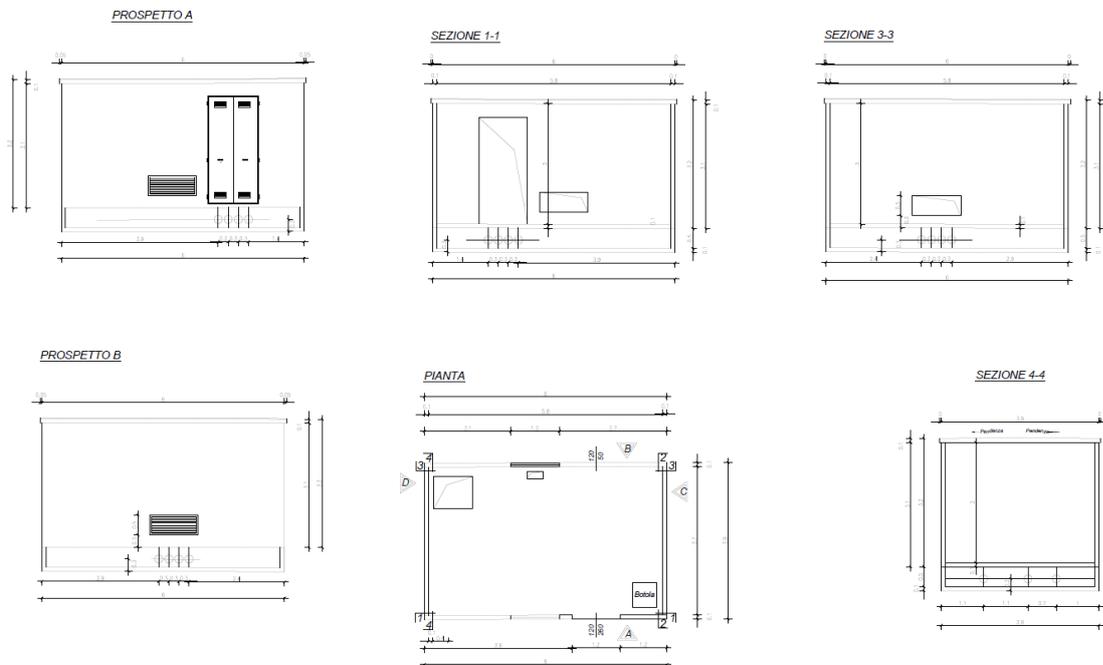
prospetti, sezione e pianta delle cabine di sottocampo.
